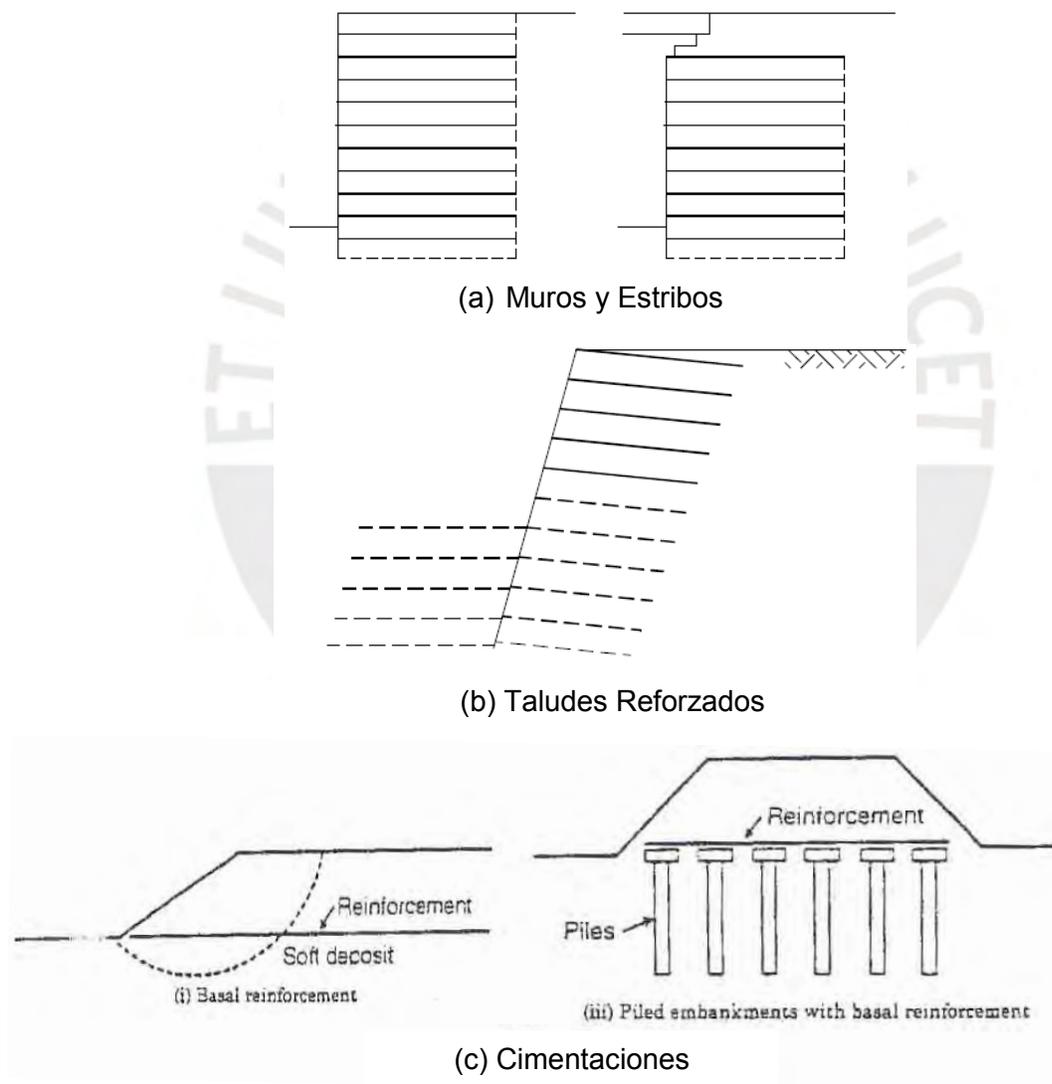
2: Aplicaciones de tipos de suelo reforzado Fuente: (Railways, 2005)
